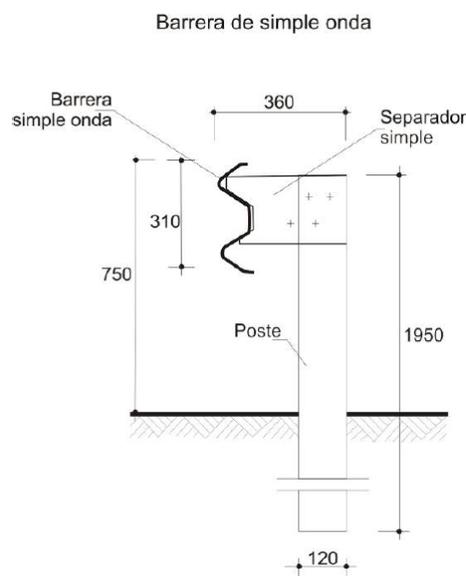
Barrera metálica con viga tipo perfil W. Fuente: DNV
